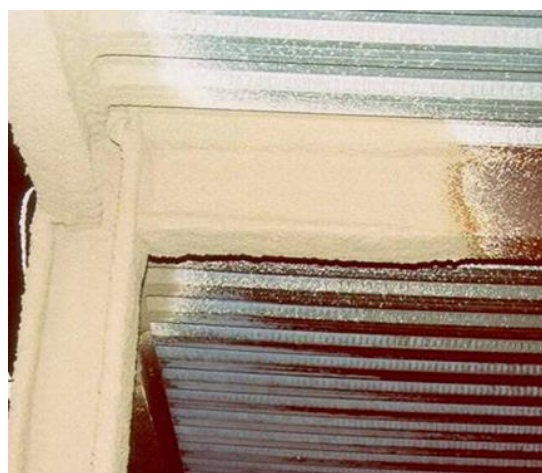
Proteção dos pilares e ligação às vigas.
